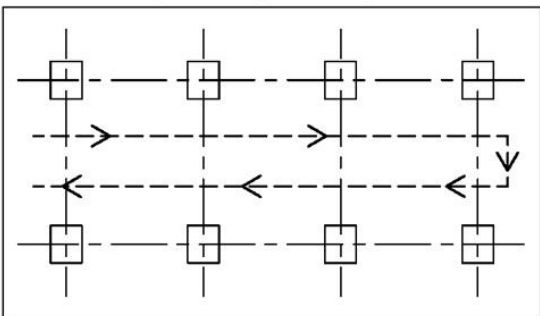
Схемы устройства монолитных железобетонных фундаментов в общем котловане:
